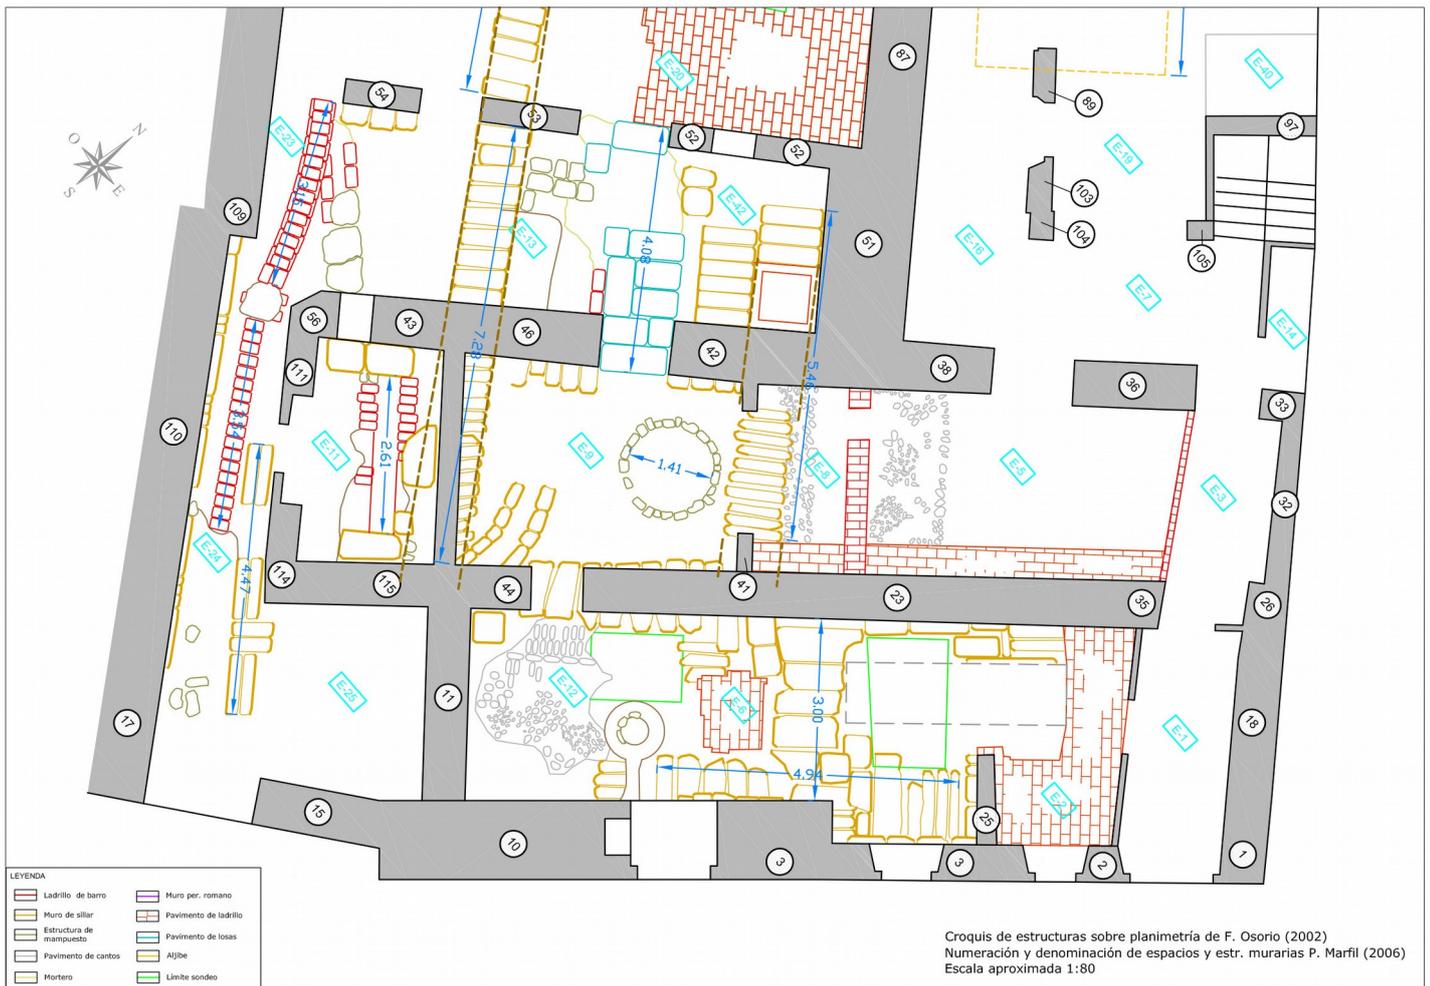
Croquizado Parcial 01 de las estructuras del Baño de la Pescadería o de la calle Cara.
